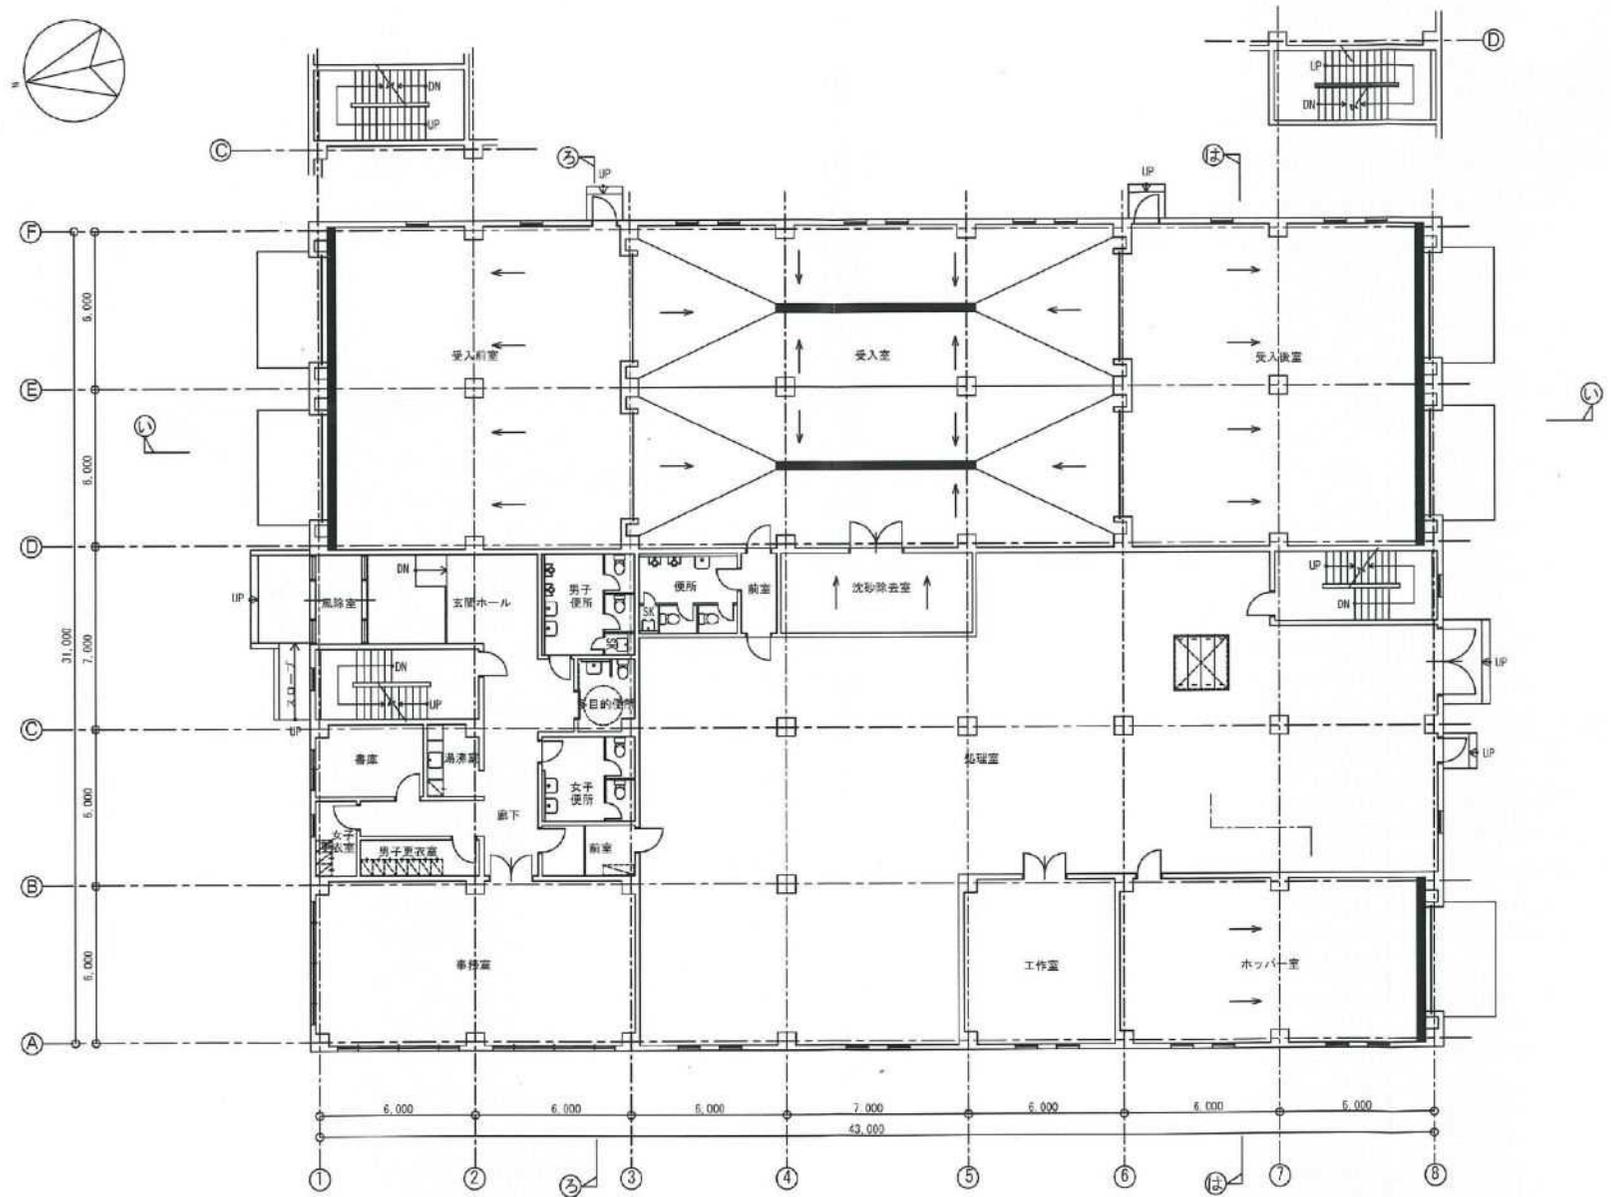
改修整備後の機器配置図 (1 階平面図 (案))
